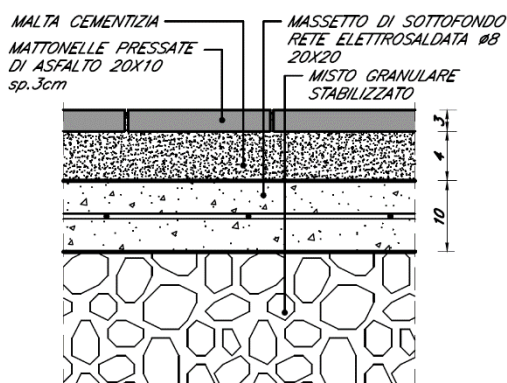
Dettaglio pacchetto H14 e schema di posa
